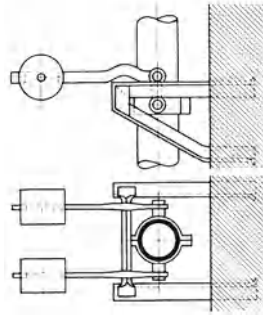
Konsol mit Hebel und Gewichtsausgleich.
